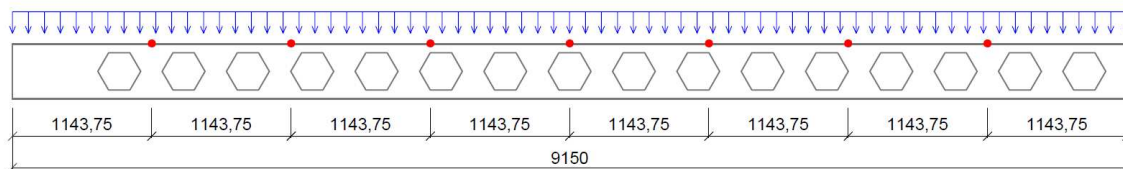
Carregamento distribuído aplicado nas vigas analisadas em forma de pressão.
